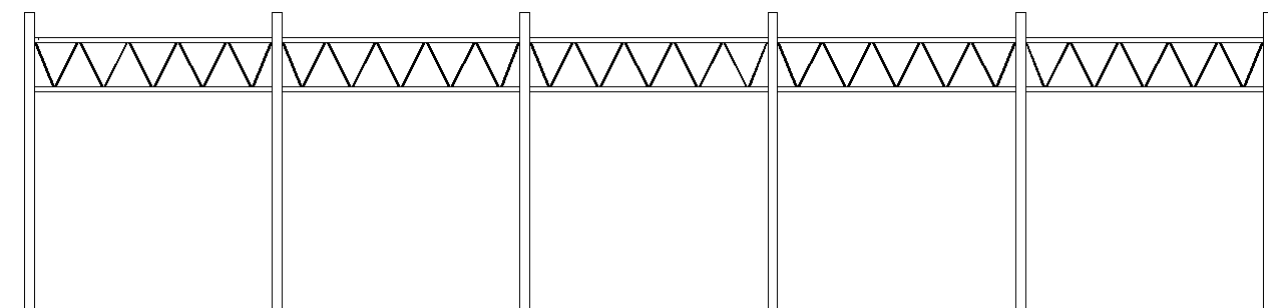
Estructura longitudinal rigidizada con armadura rígida en marcos continuos.
